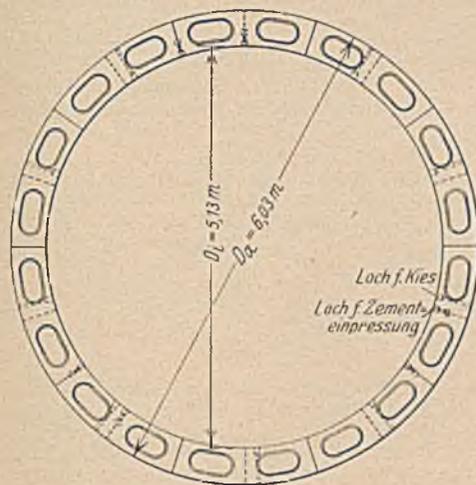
Betonblöcke für die Tunnelauskleidung.
